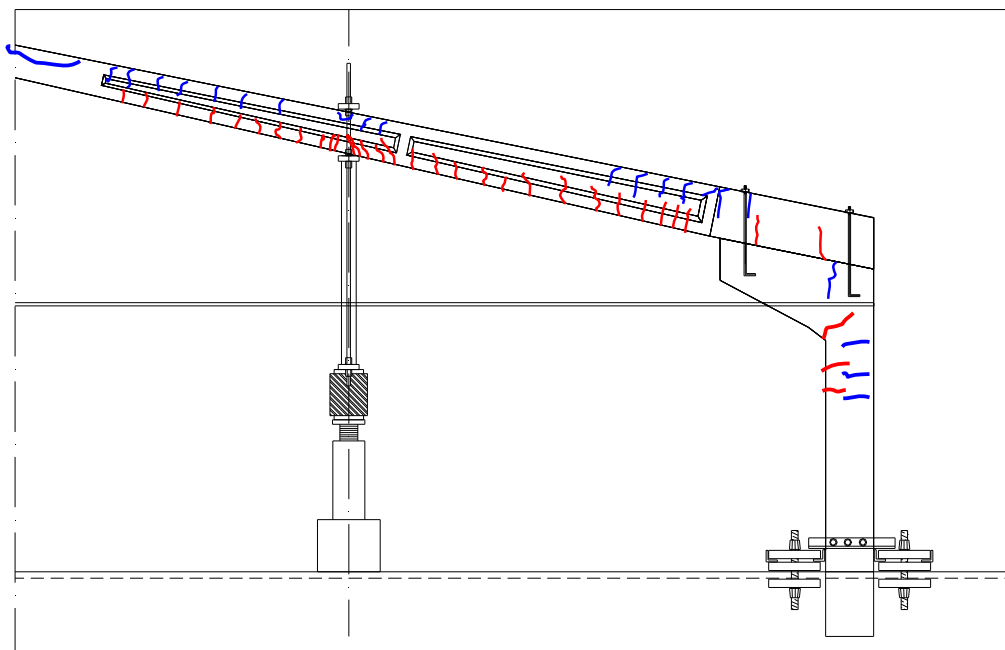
Fissura ao Longo das estruturas
